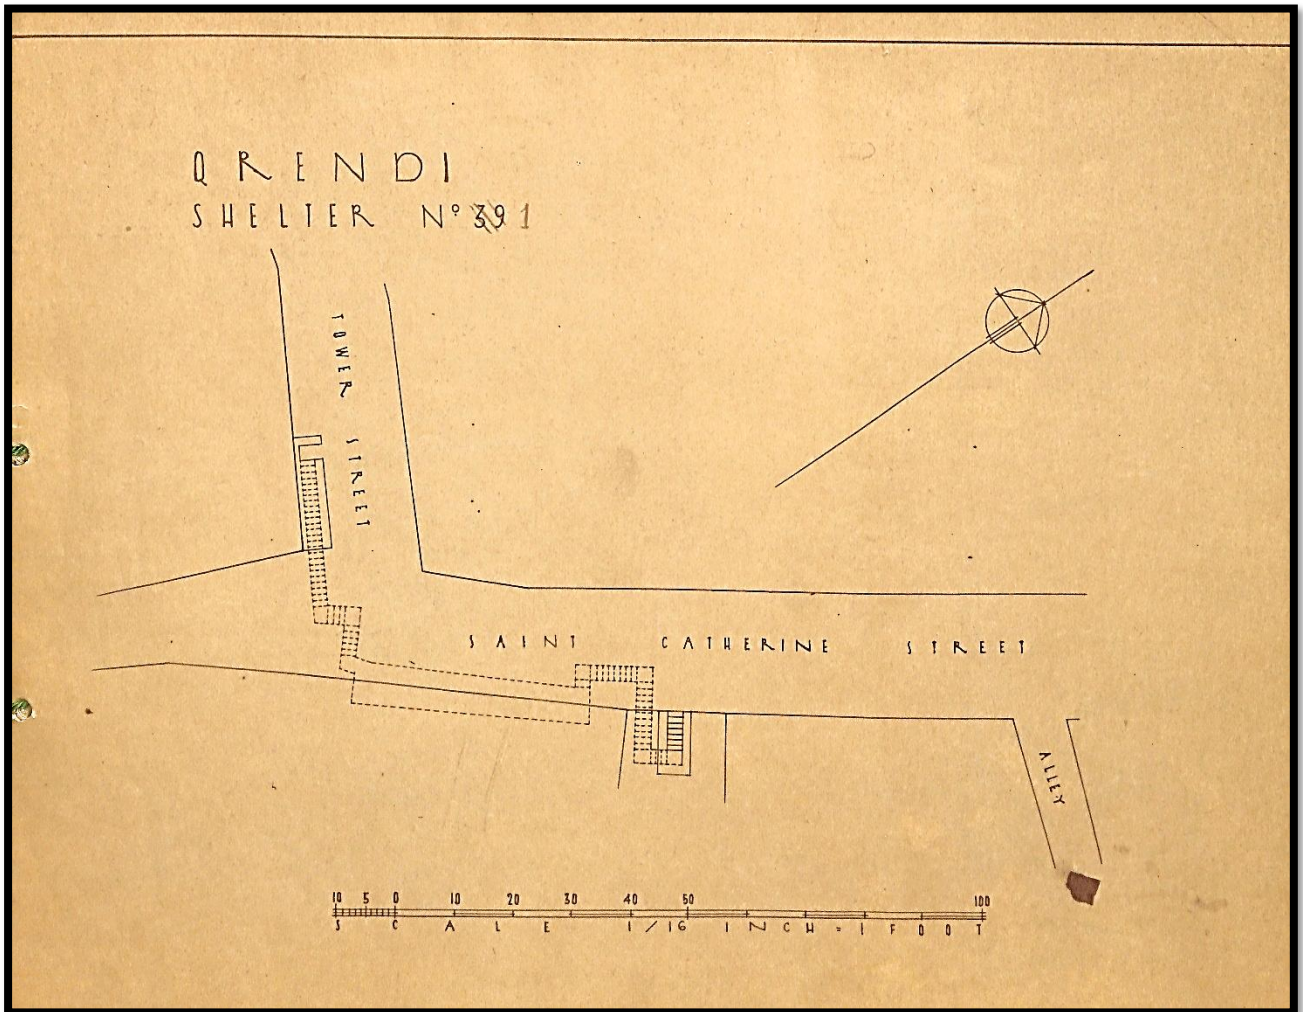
Planta do Abrigo nº1 "Sant Catherine Street – Tower Street – Alley."
